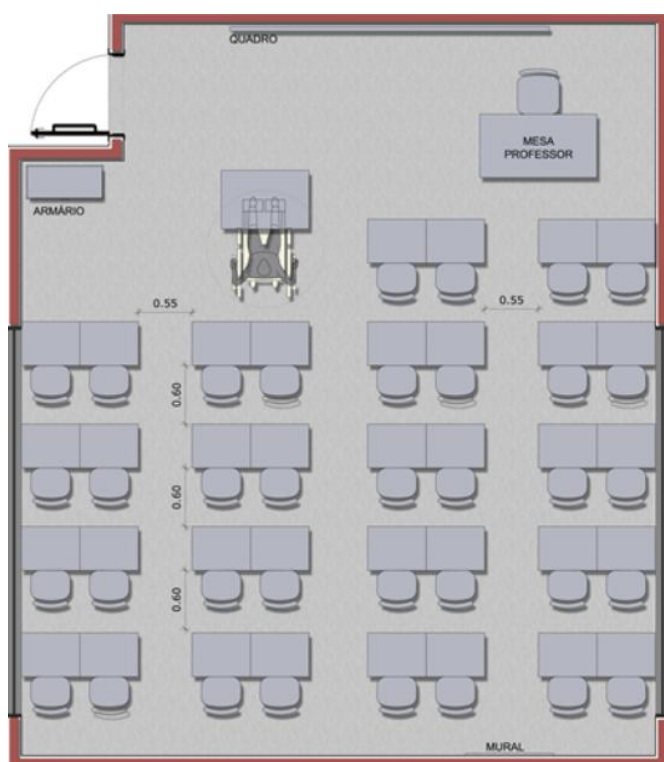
Planta baixa de sala de aula padrão FNDE, com layout rígido.
